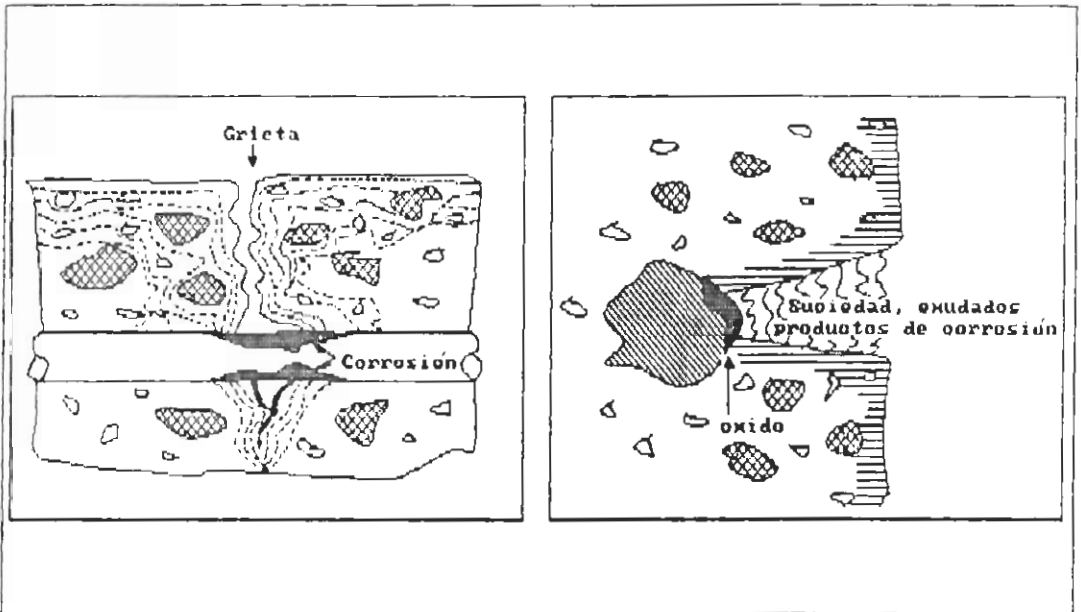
Corrosión en fisuras transversales y longitudinales.
